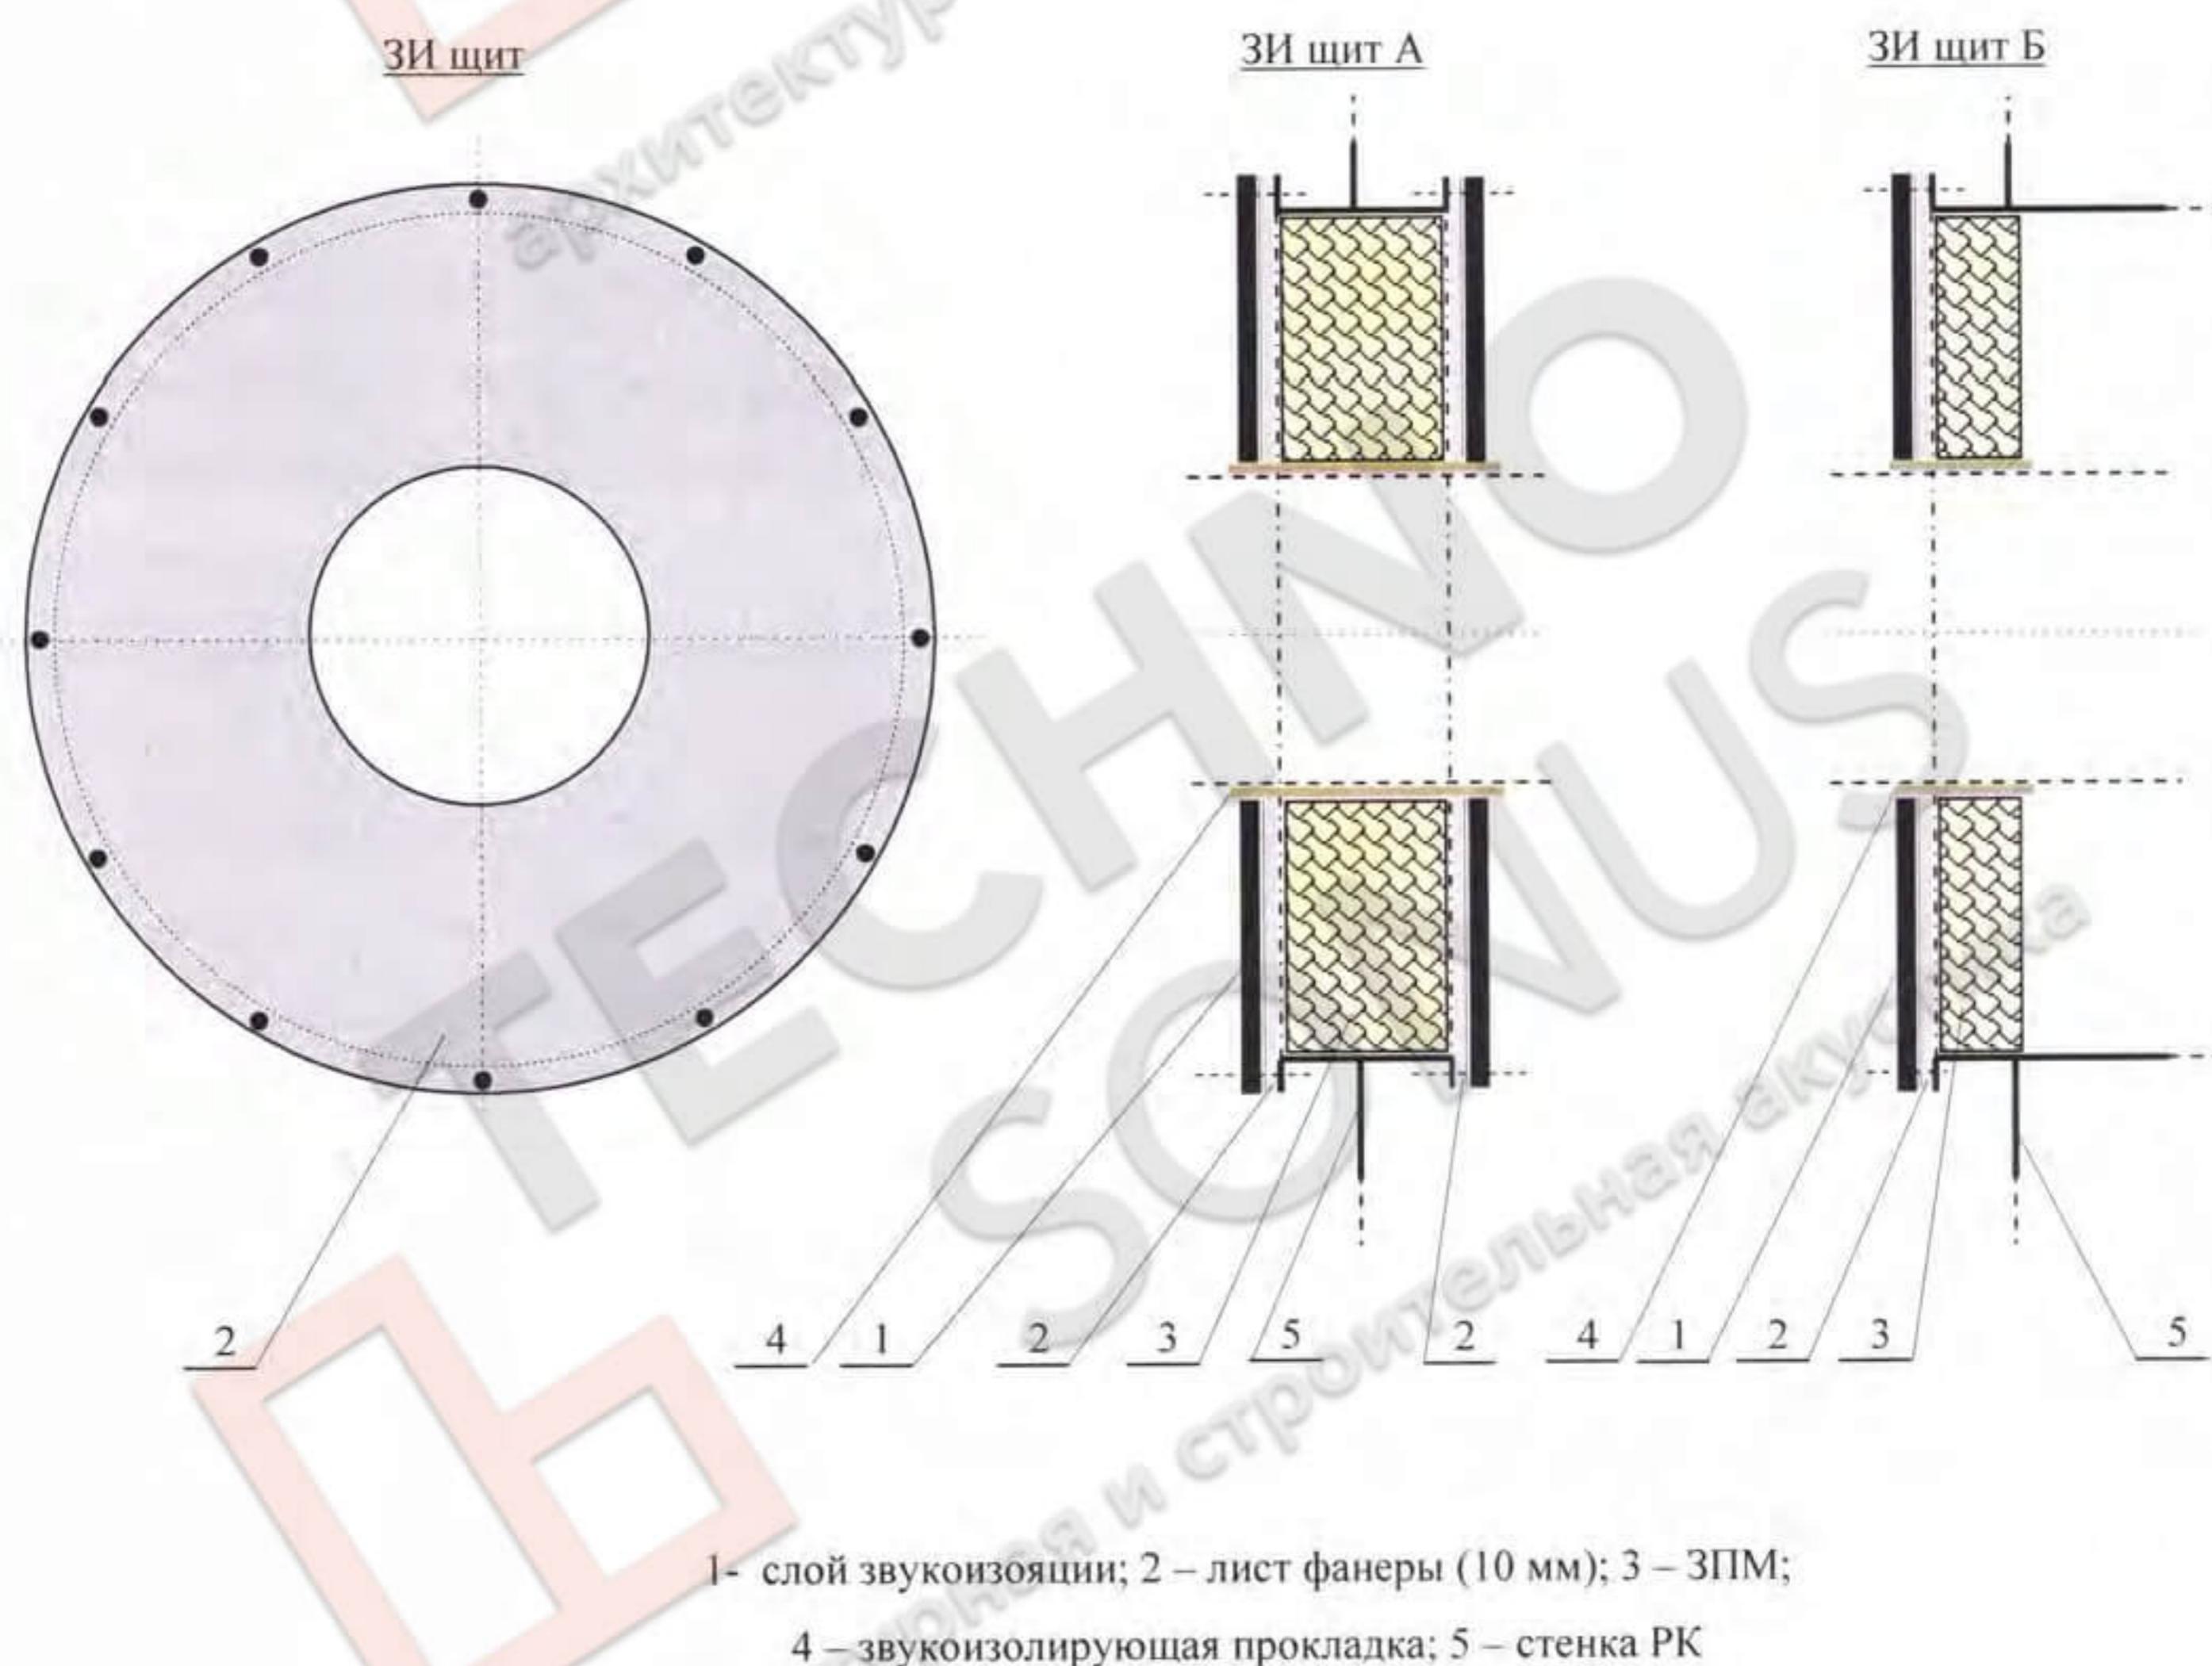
Конструкции ЗИ щитов для прохода испытательной трубы
